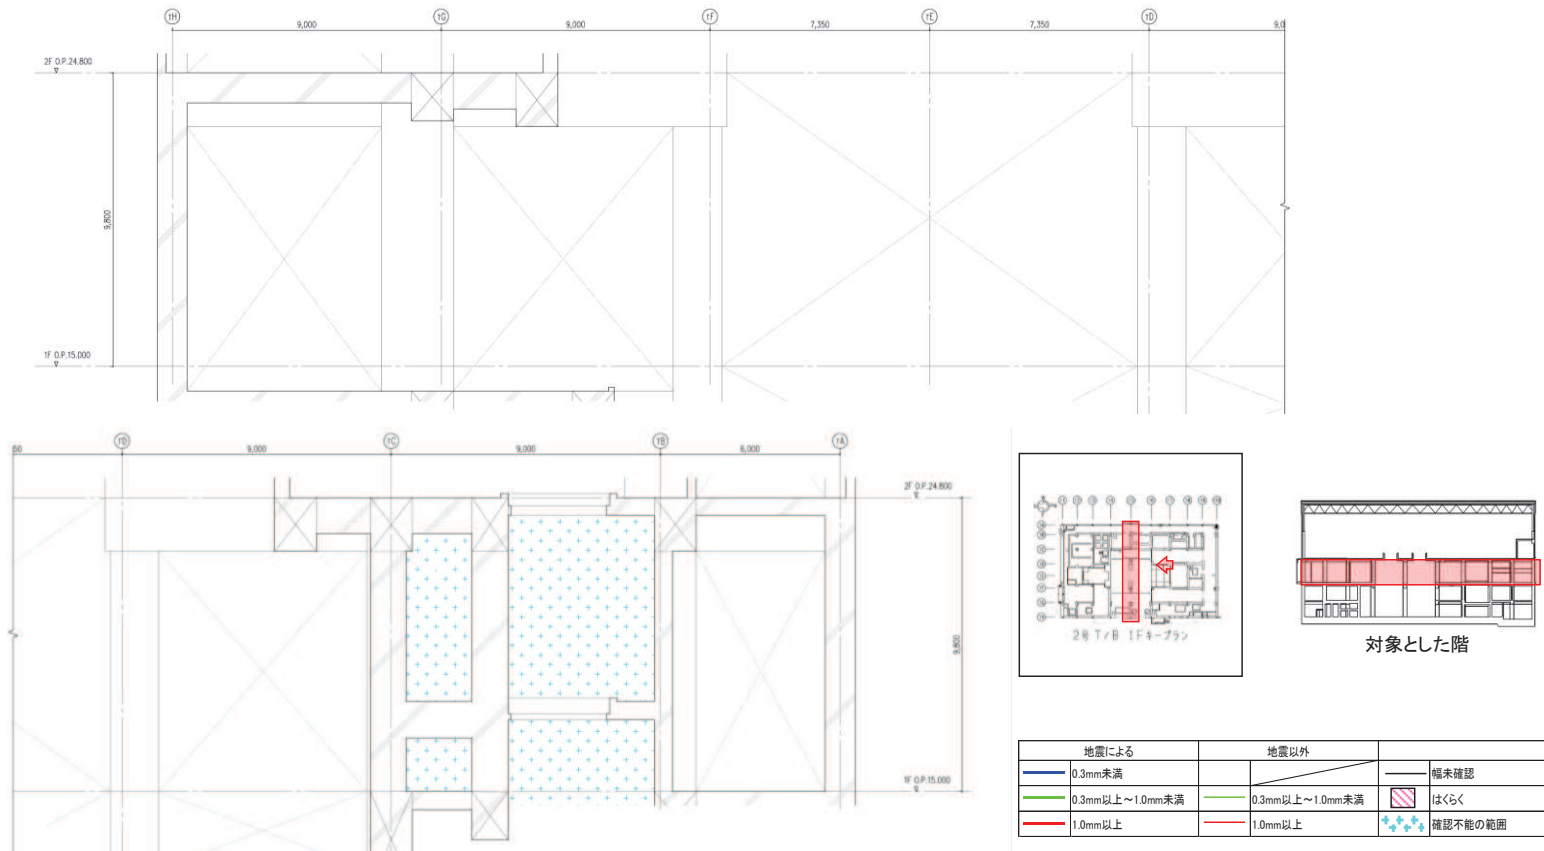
タービン建屋のひび割れ分布 耐震壁 (37) 1階 T5 通り
